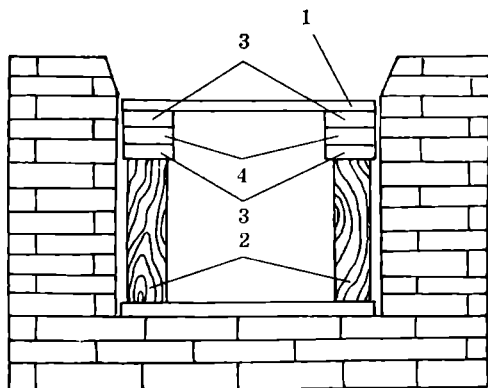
Опалубка для кладки клинчатой перемычки проема камина:
